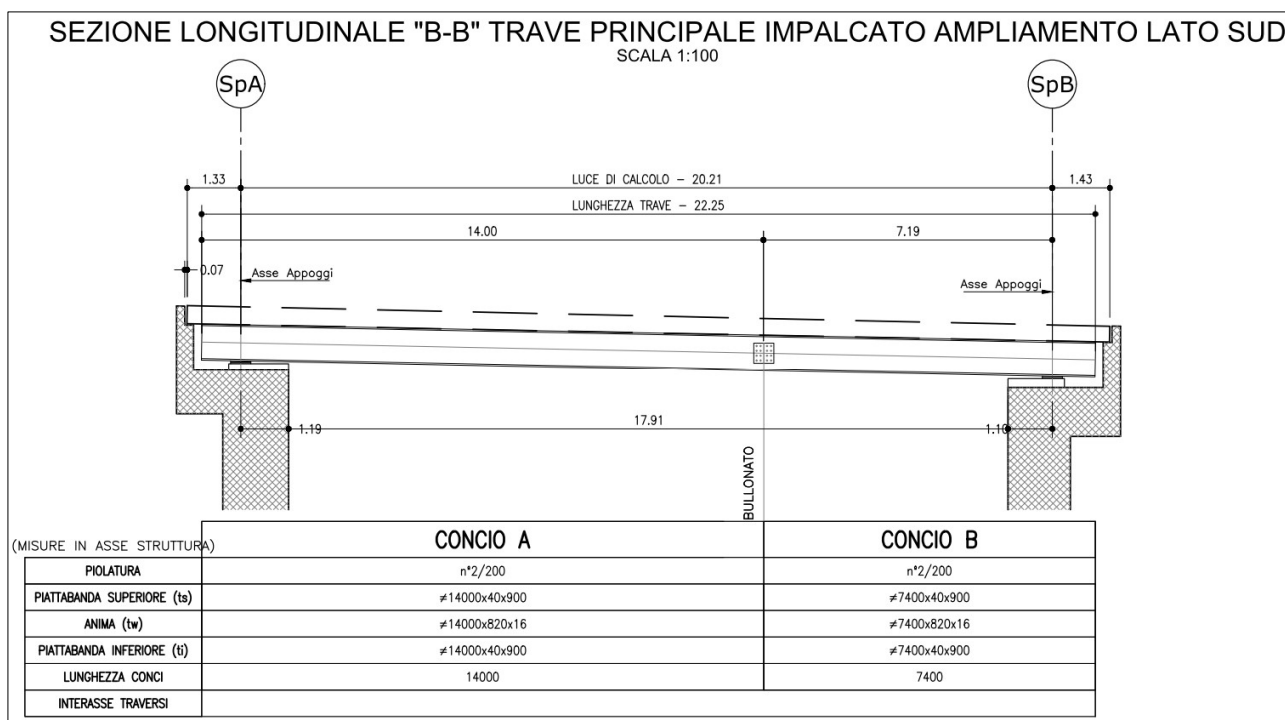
Sezione longitudinale trave in ampliamento – Lato Sud
